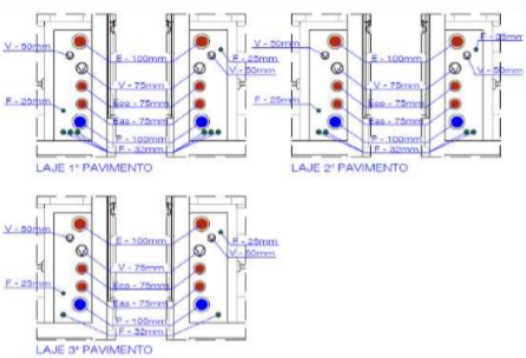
Detalhamento das prumadas no shaft por pavimento.
